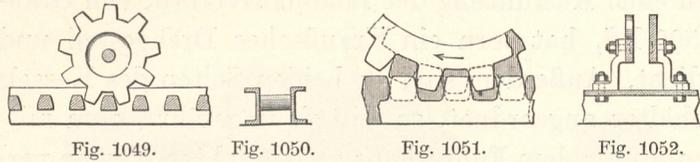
Fig. 1050. Riggenbachsche Zahnstange (Fig. 1049 Ansicht, Fig. 1050 Querschnitt). Fig. 1051 und 1052. Abts zweiteilige Zahnstange (Fig. 1051 Ansicht mit Eingriff des Zahnrades, Fig. 1052 Querschnitt mit Befestigung auf eiserner Querschelle).
